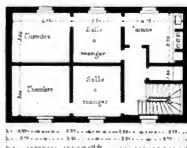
Plan du rez-de-chaussée à 0 005 p 1^m
